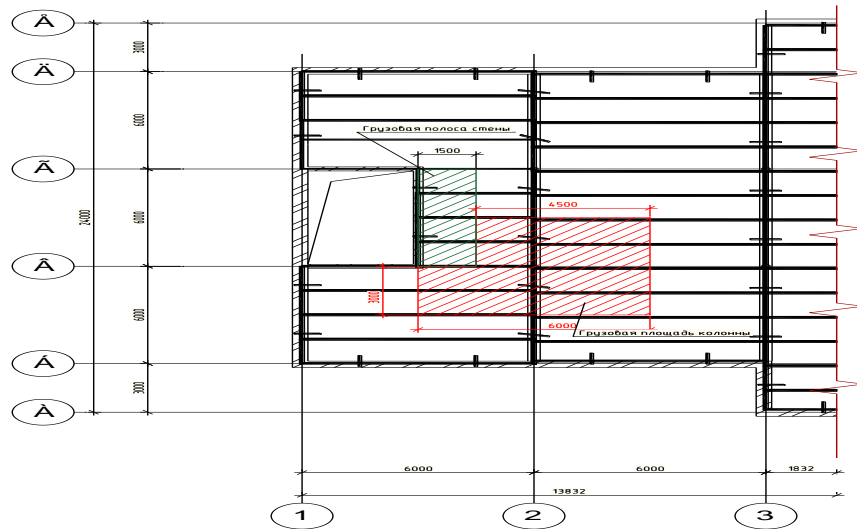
грузовые площади стены и колонны междуэтажного перекрытия
